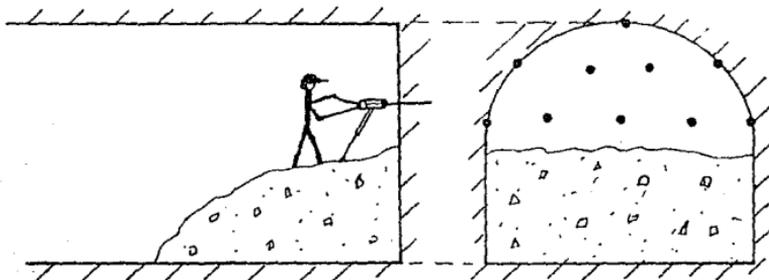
Barrenación sección superior, apoyando las perforadoras en la rezaga.
